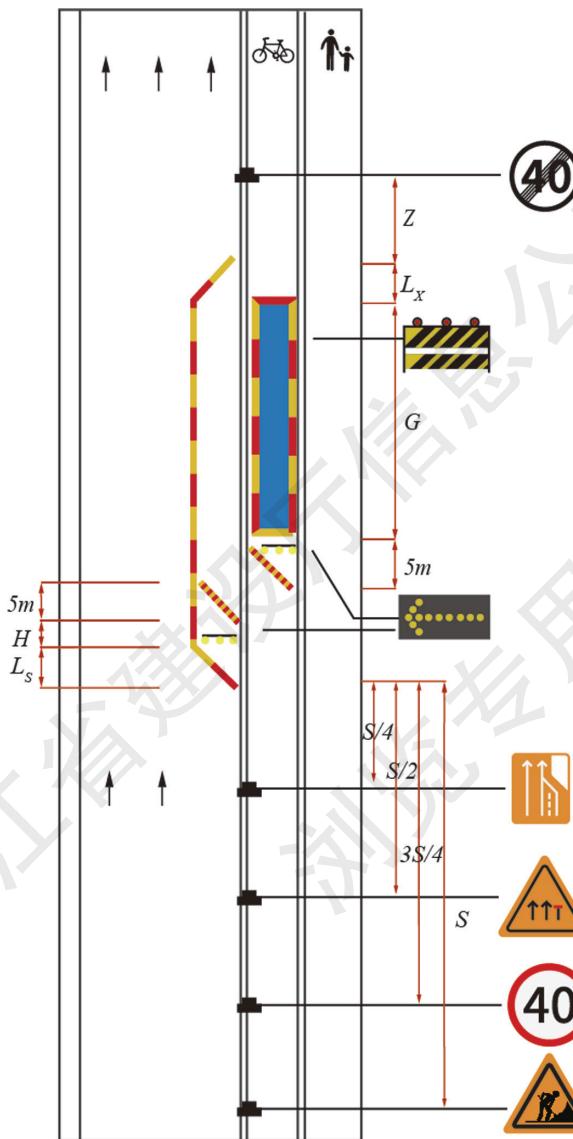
主干道非机动车道养护作业控制区布置示意
